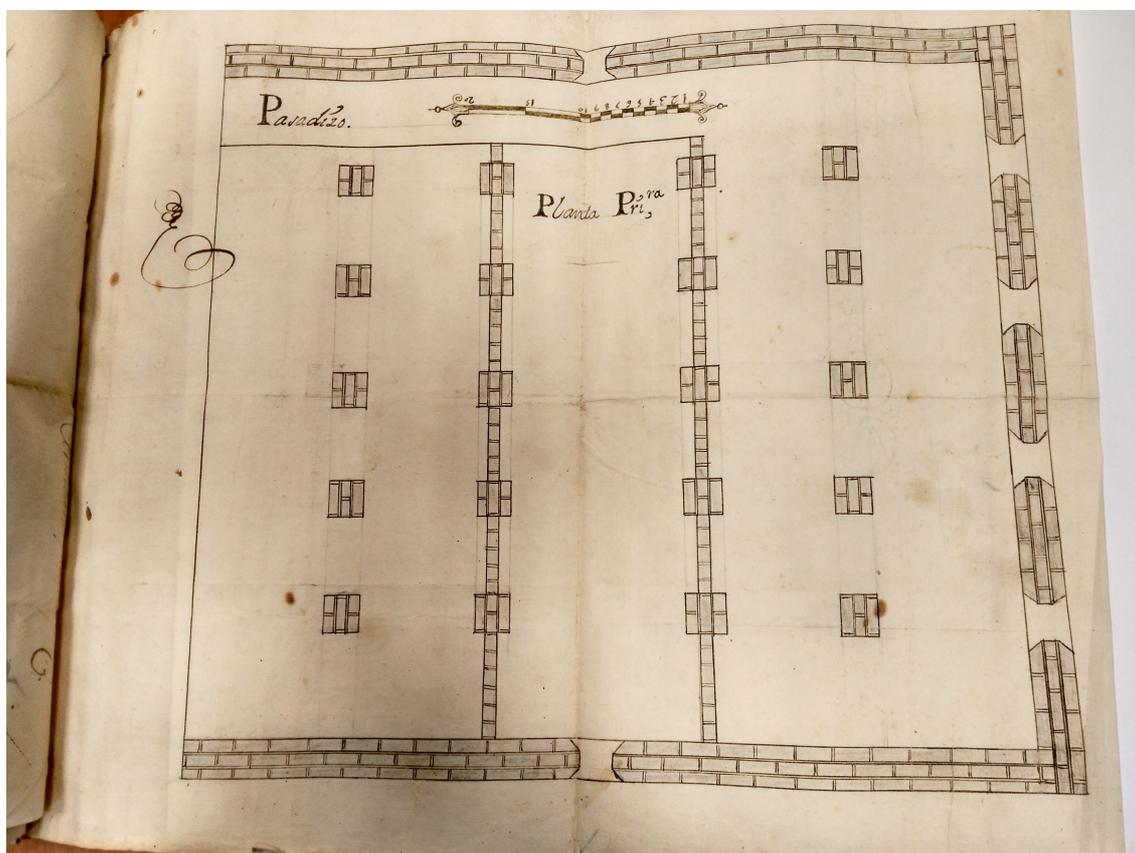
FIGURA V. Planta Primera del pósito y alhóndiga de Burgos en 1742¹²⁸
